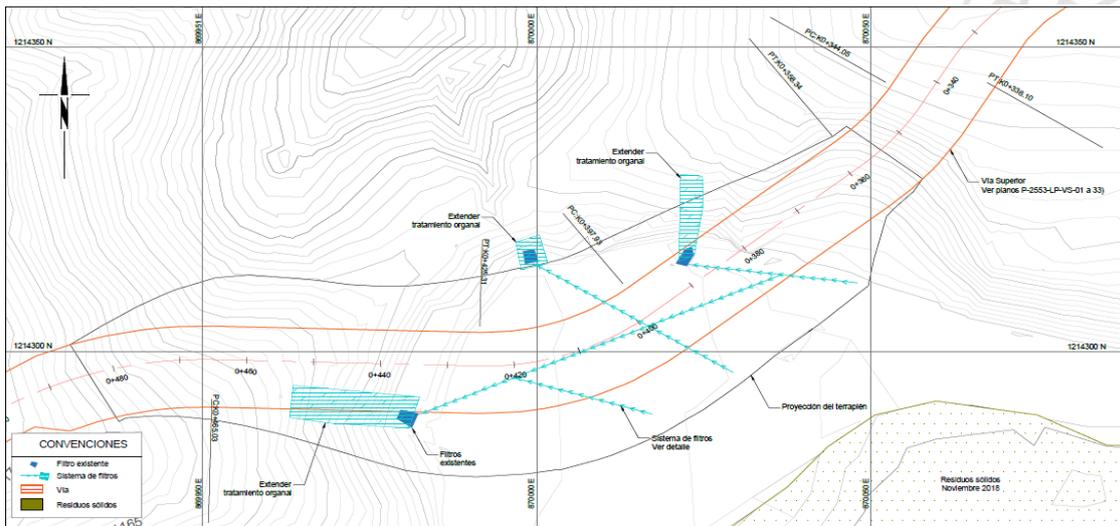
Vista en planta con localización de filtros (Inteinsa 2018)
